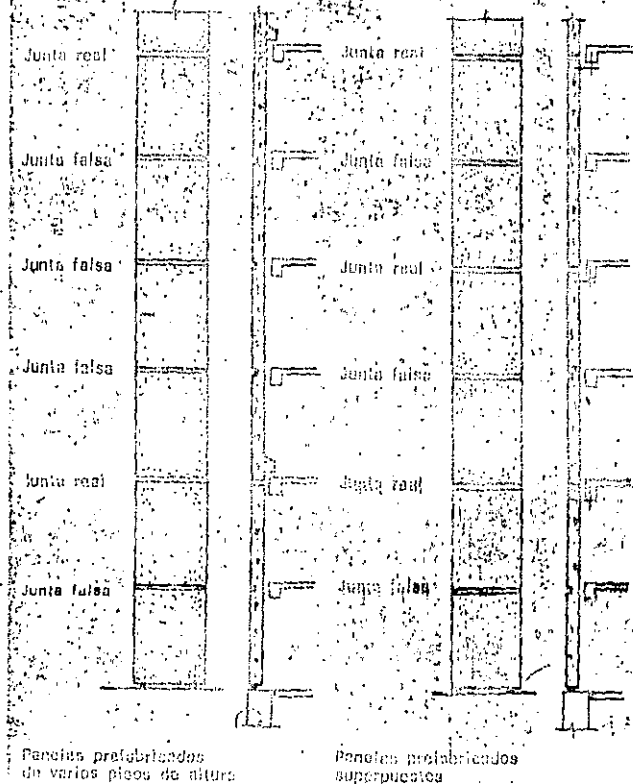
ELEMENTOS PREFABRICADOS PARA EDIFICIOS CON PLACAS DE FORJADO EN VOLADIZO
